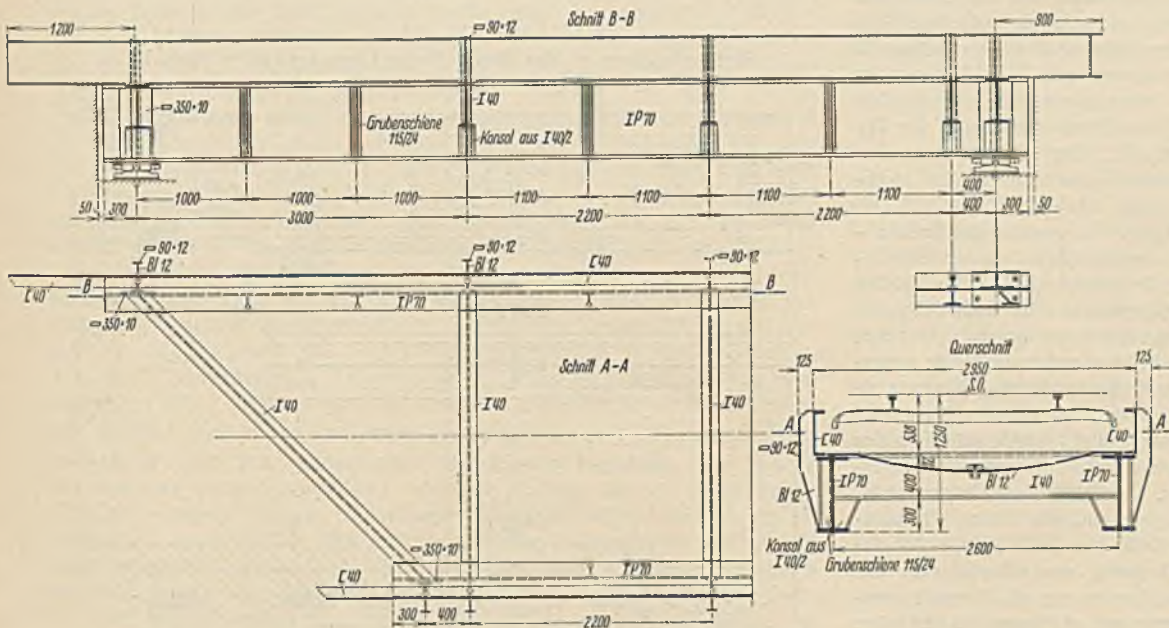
Längsschnitt, Teilgrundriß und Querschnitt eines Überbaues der Obergrabenbrücke nach dem Umbau.
